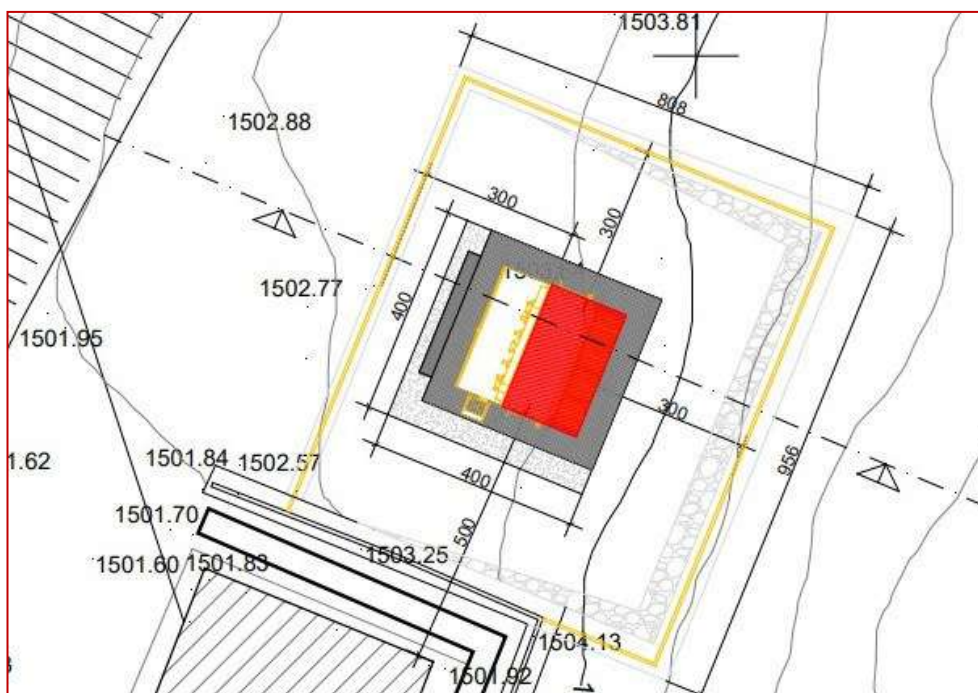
Estratto Elaborato 01 - Planimetria di progetto
